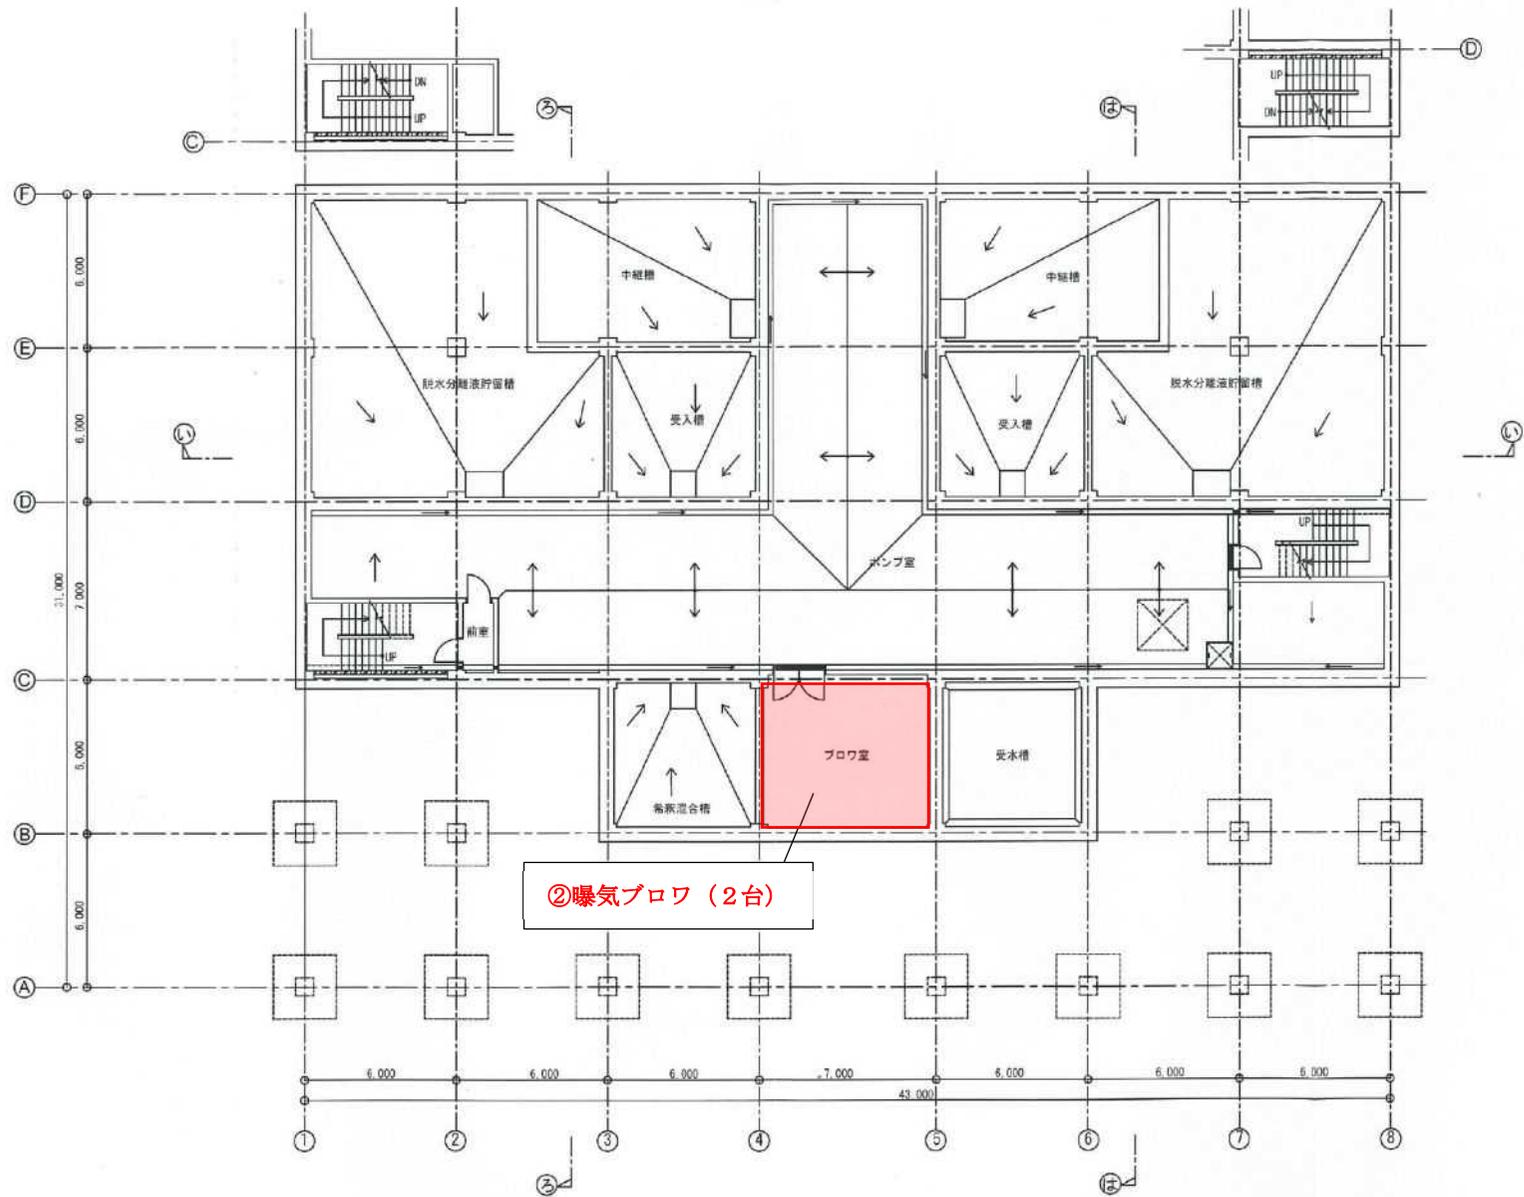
改修整備後の機器配置図 (地階平面図 (案))
